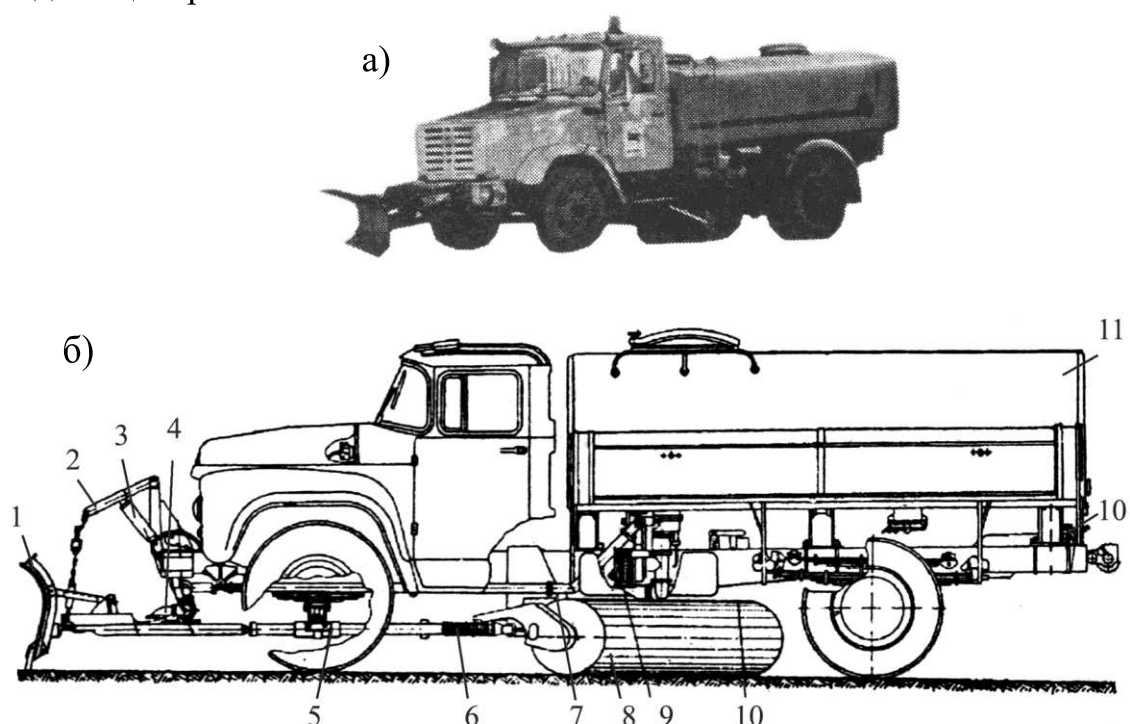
Поливомоечная машина: а) – общий вид; б) – схема устройства машины: 1 – плужный рабочий орган; 2 – механизм подъема; 3 – гидроцилиндр; 4 – шарнирные моечные сопла насадок; 5 – кран управления; 6 – толкающая рама; 7 – трубопровод; 8 – щетка с ворсом; 9 – насосная установка ПН-1200А; 10 – кран разобщик; 11 – цистерна
